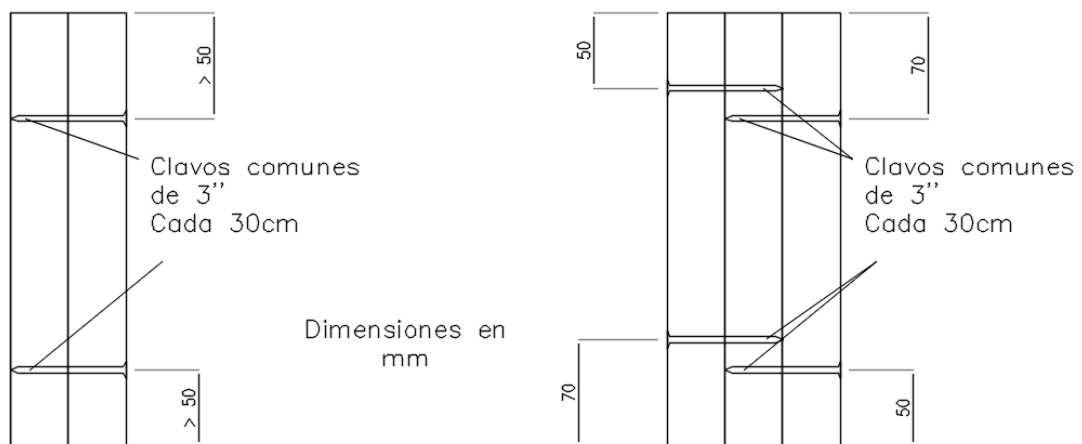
Esquema de Clavado para Vigas Múltiples
